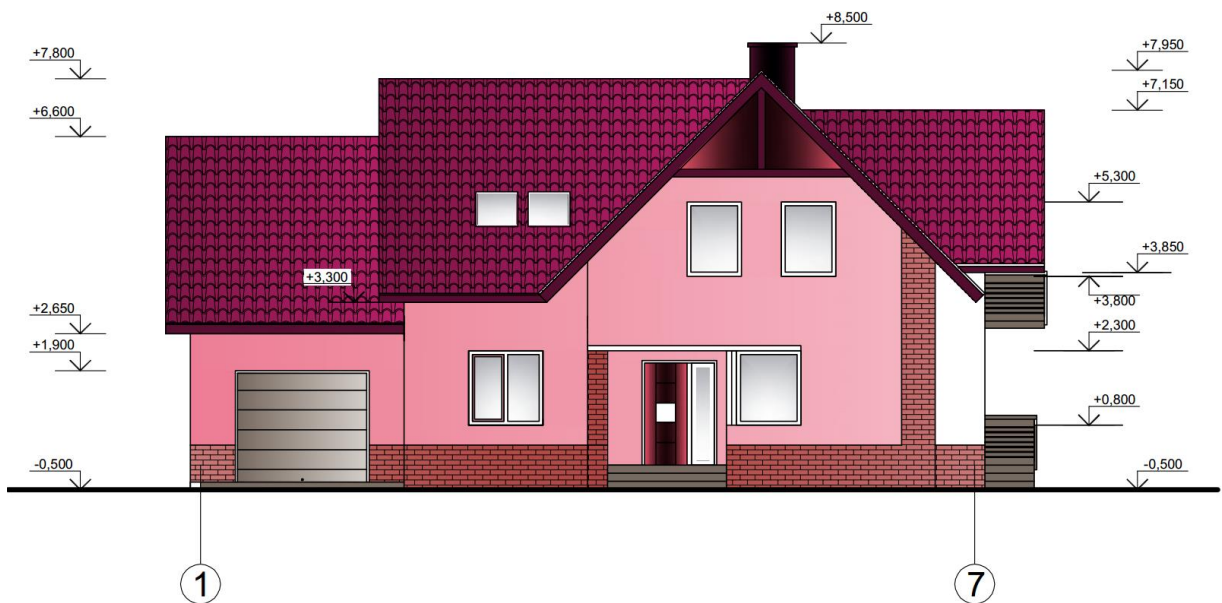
Фасад будівлі житлового комплексу котеджного типу екологічного спрямування
